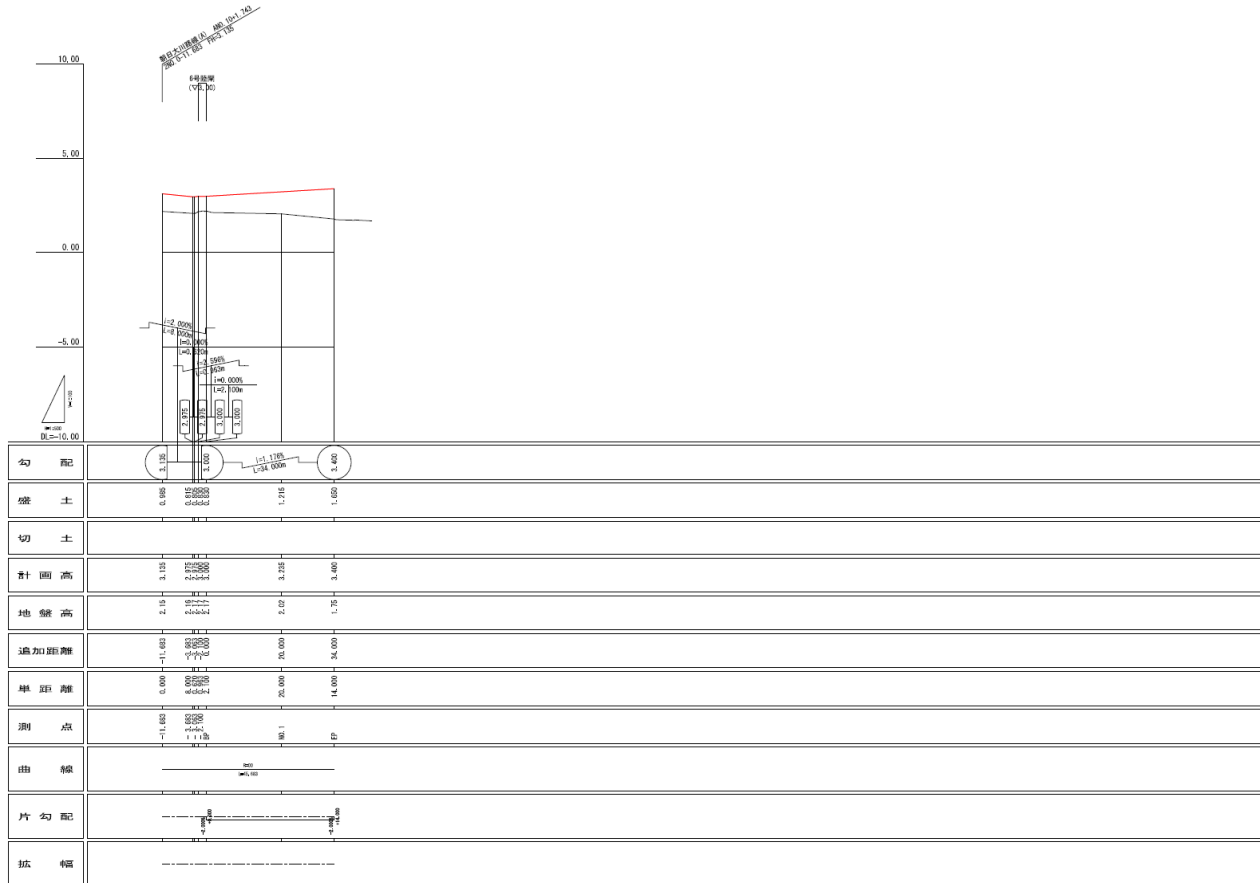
No.3 埠頭西 2 号線縦断面図（復旧後）
